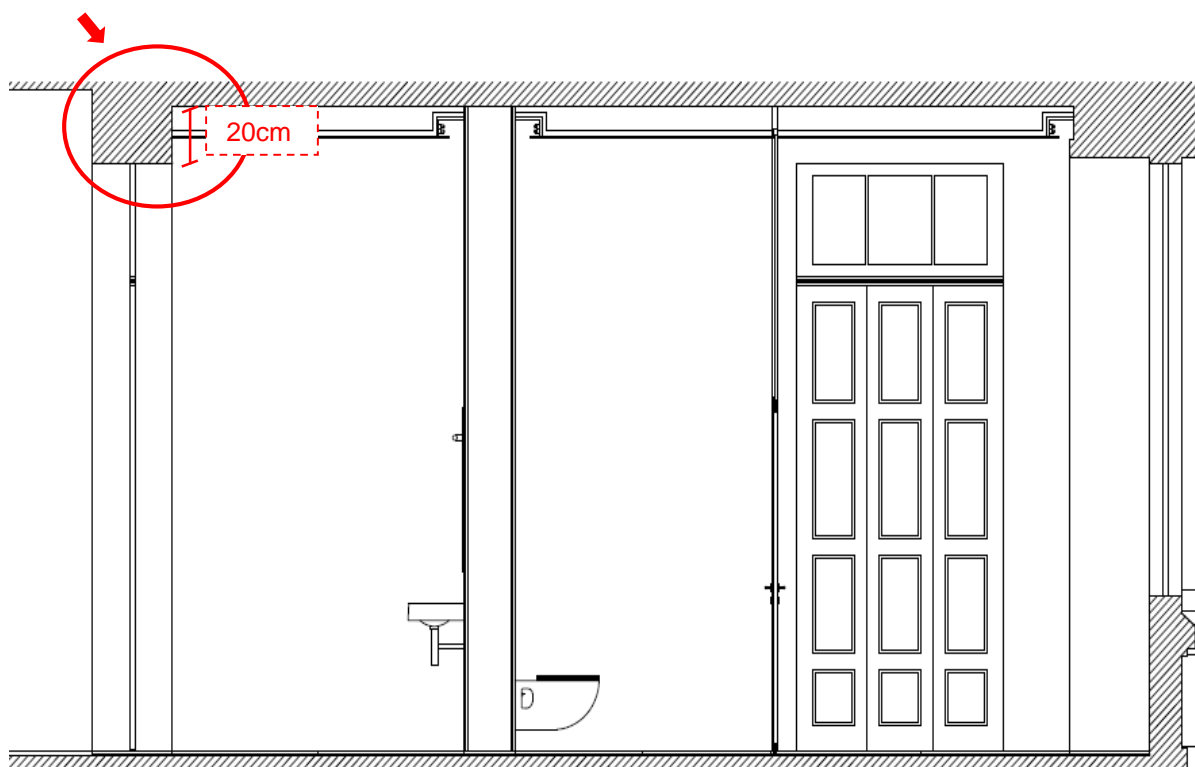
Corte, sem pormenorização, das instalações sanitárias 1.13 e 1.14
